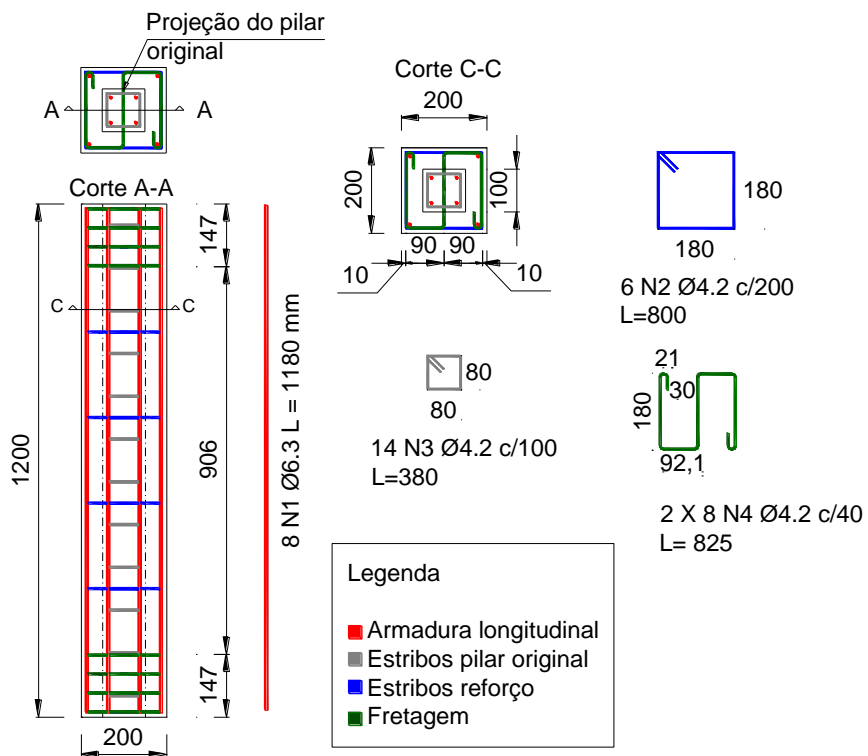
Detalhamento das armaduras dos pilares com fretagem
